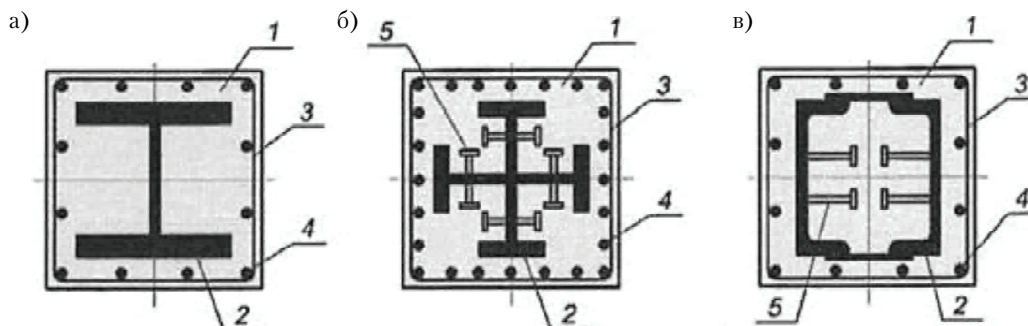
Типовые поперечные сечения сталежелезобетонных конструкций: а) жесткая арматура в форме двутавра; б) жесткая арматура в форме крестообразного сечения; в) жесткая арматура коробчатого сечения; 1 – бетон; 2 – жесткая внутренняя арматура; 3 – жесткая наружная арматура; 4 – продольная гибкая арматура; 5 – упор.
